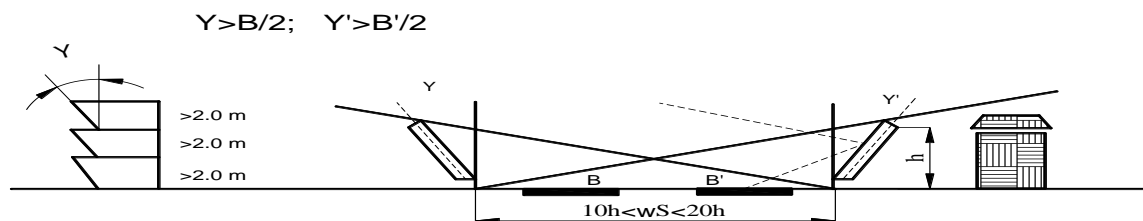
Схема ступенчатого шумоотражающего барьера с основными геометрическими размерами
